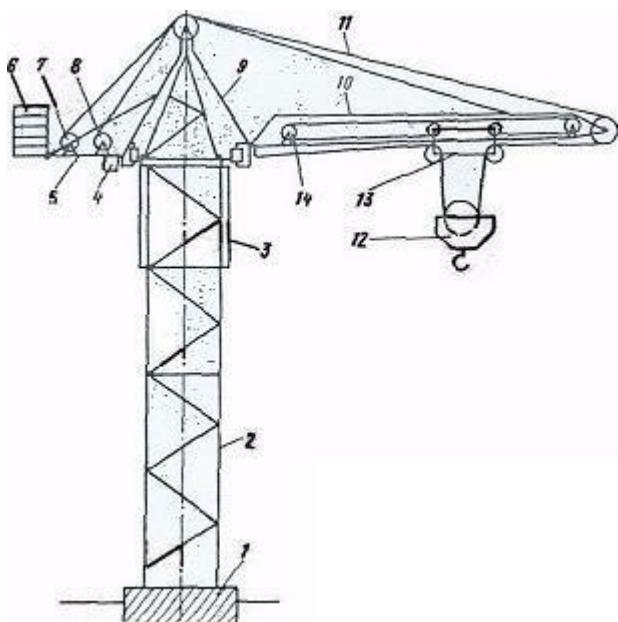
Схема баштового крана з неповоротною баштою:
